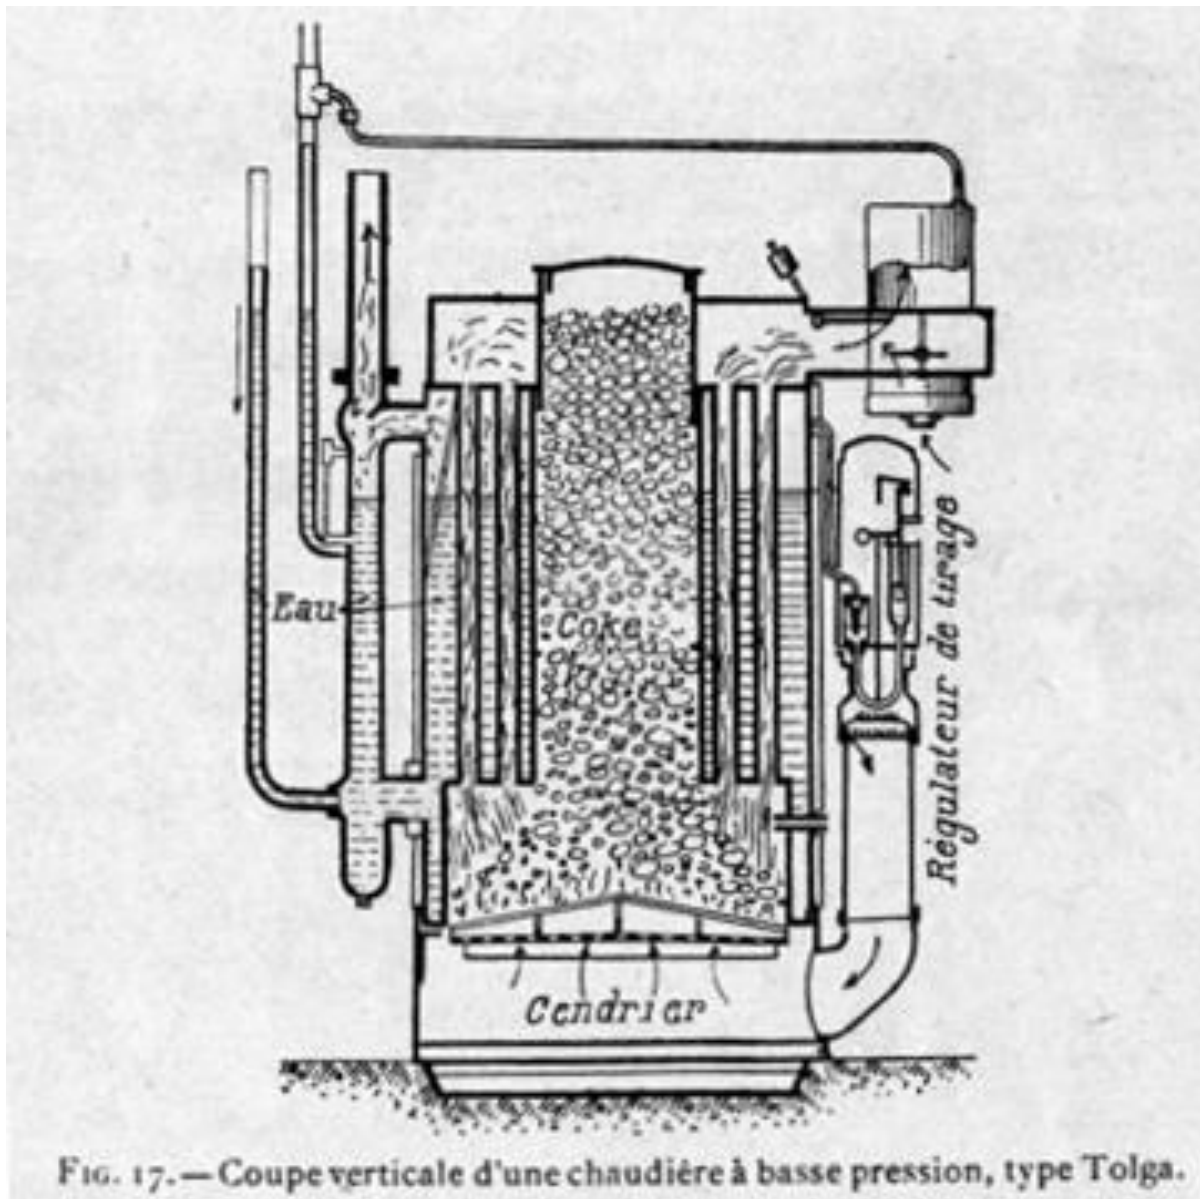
Coupe verticale d'une chaudière à basse pression, type Tolga.
